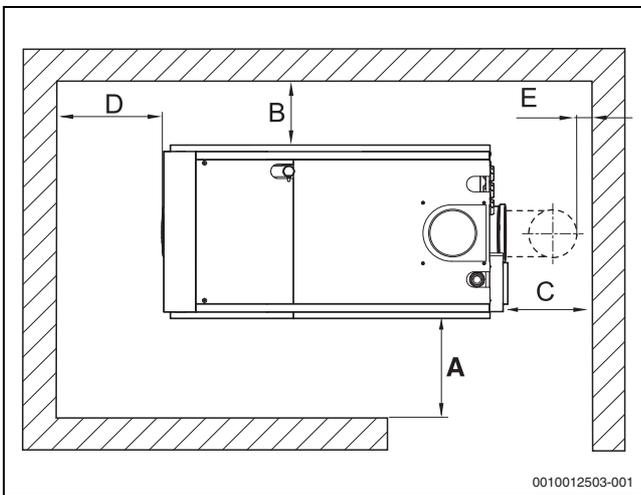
Wandabstände im Aufstellraum (Rechts-Ausführung, Einzelkessel)
